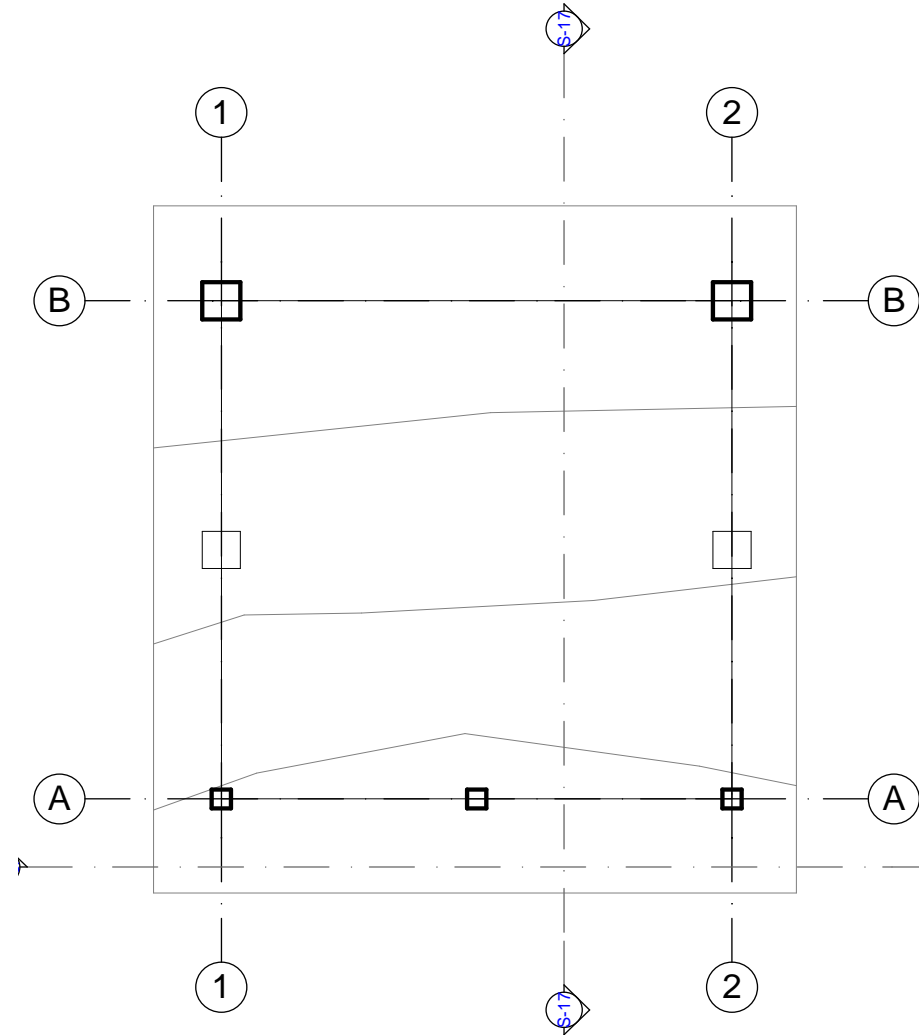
PLANTA DE CIMENTACION PROPUESTA TIPO 3
